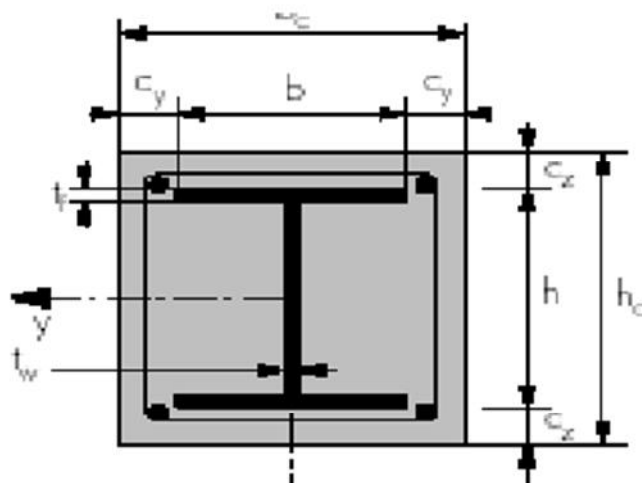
Poteau mixte totalement enrobé de béton.
